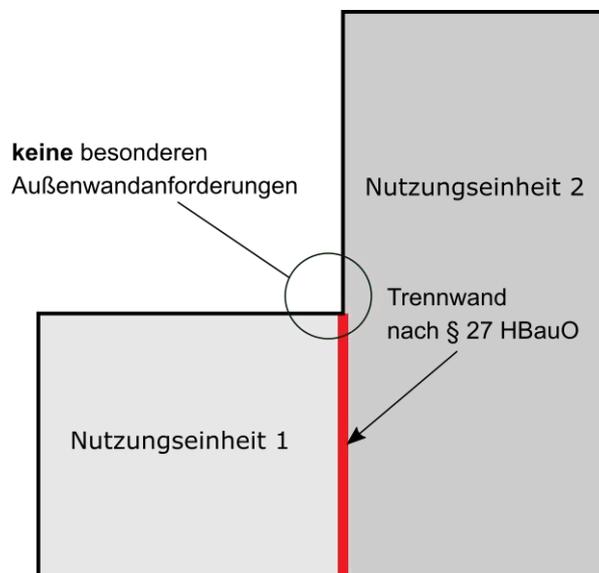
Prinzipskizze (Grundriss) für Trennwand im Eckbereich
